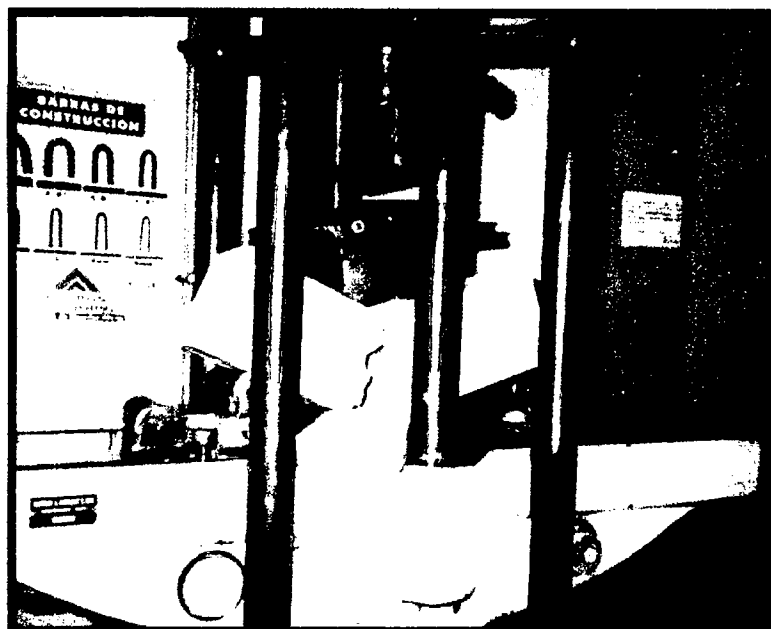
Falla y ruptura de viga sometida al ensayo de flexión.
